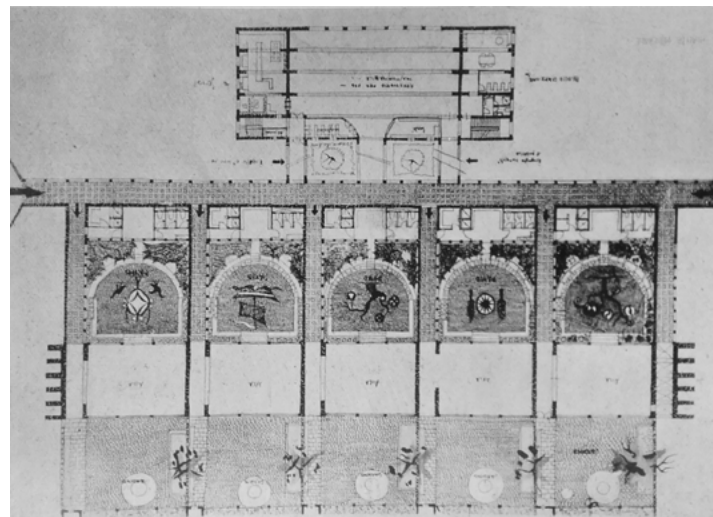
Progetto dell'arch. Furio Fasolo, pianta; via MORETTI, 1942
